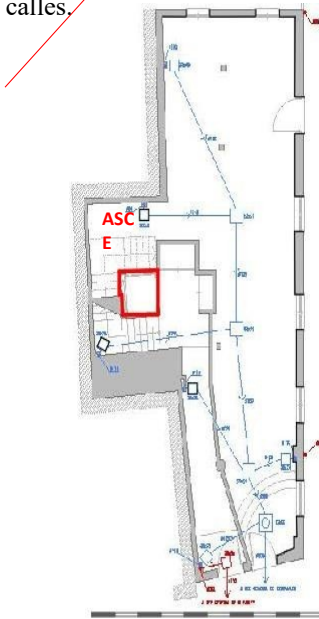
emplazamiento de la zanja de saneamiento y del sondeo (en rojo).
